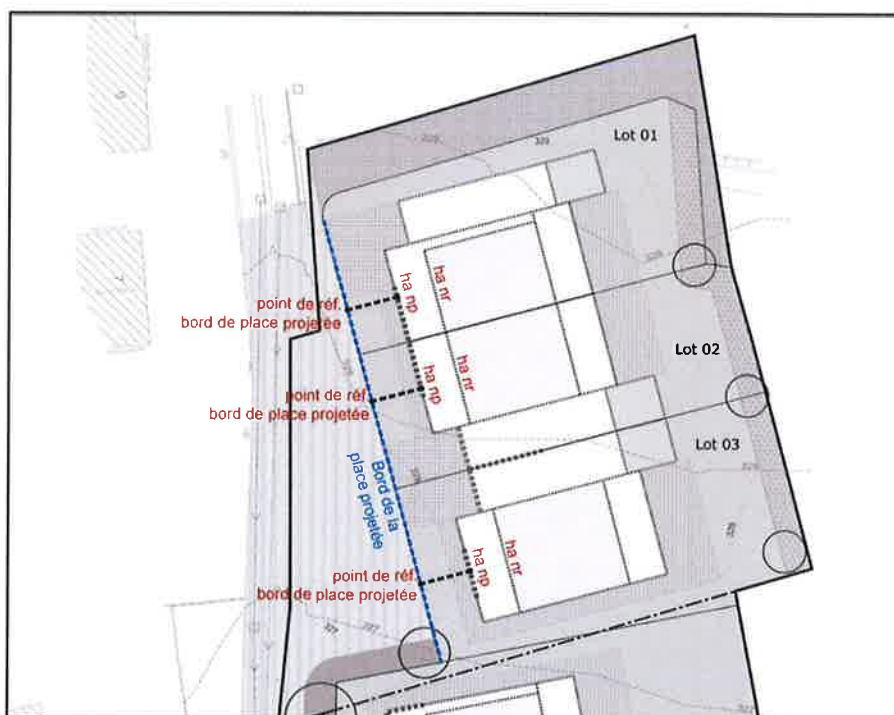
Croquis explicatif pour la définition de la hauteur à l'acrotère des lots 01, 02 et 03
